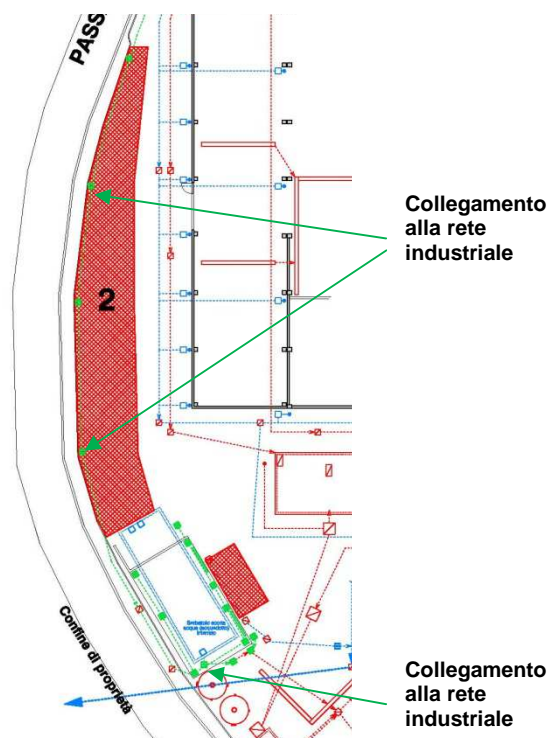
Stralcio planimetrico dell'intervento proposto in riferimento all' area n.2
